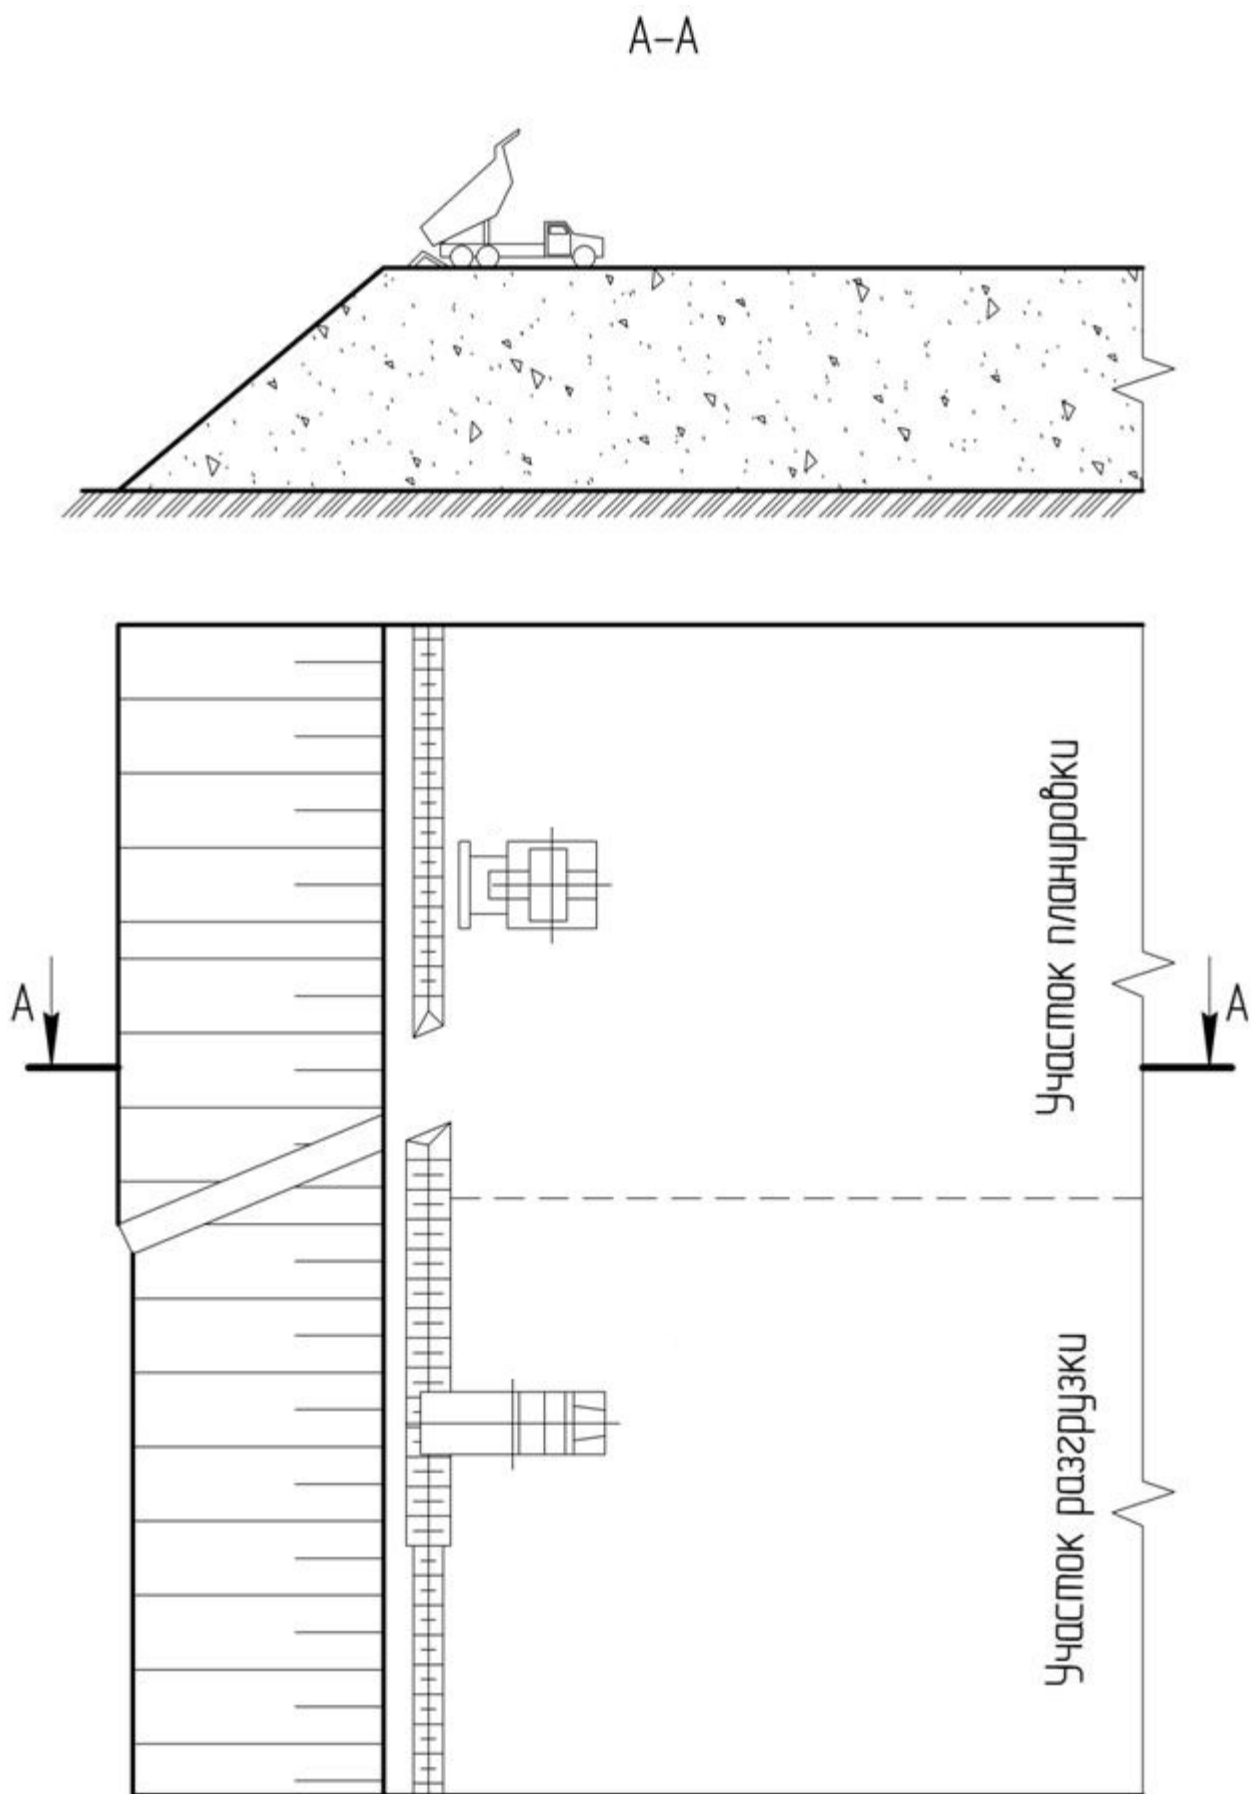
Схема планирования и формирования отвала
